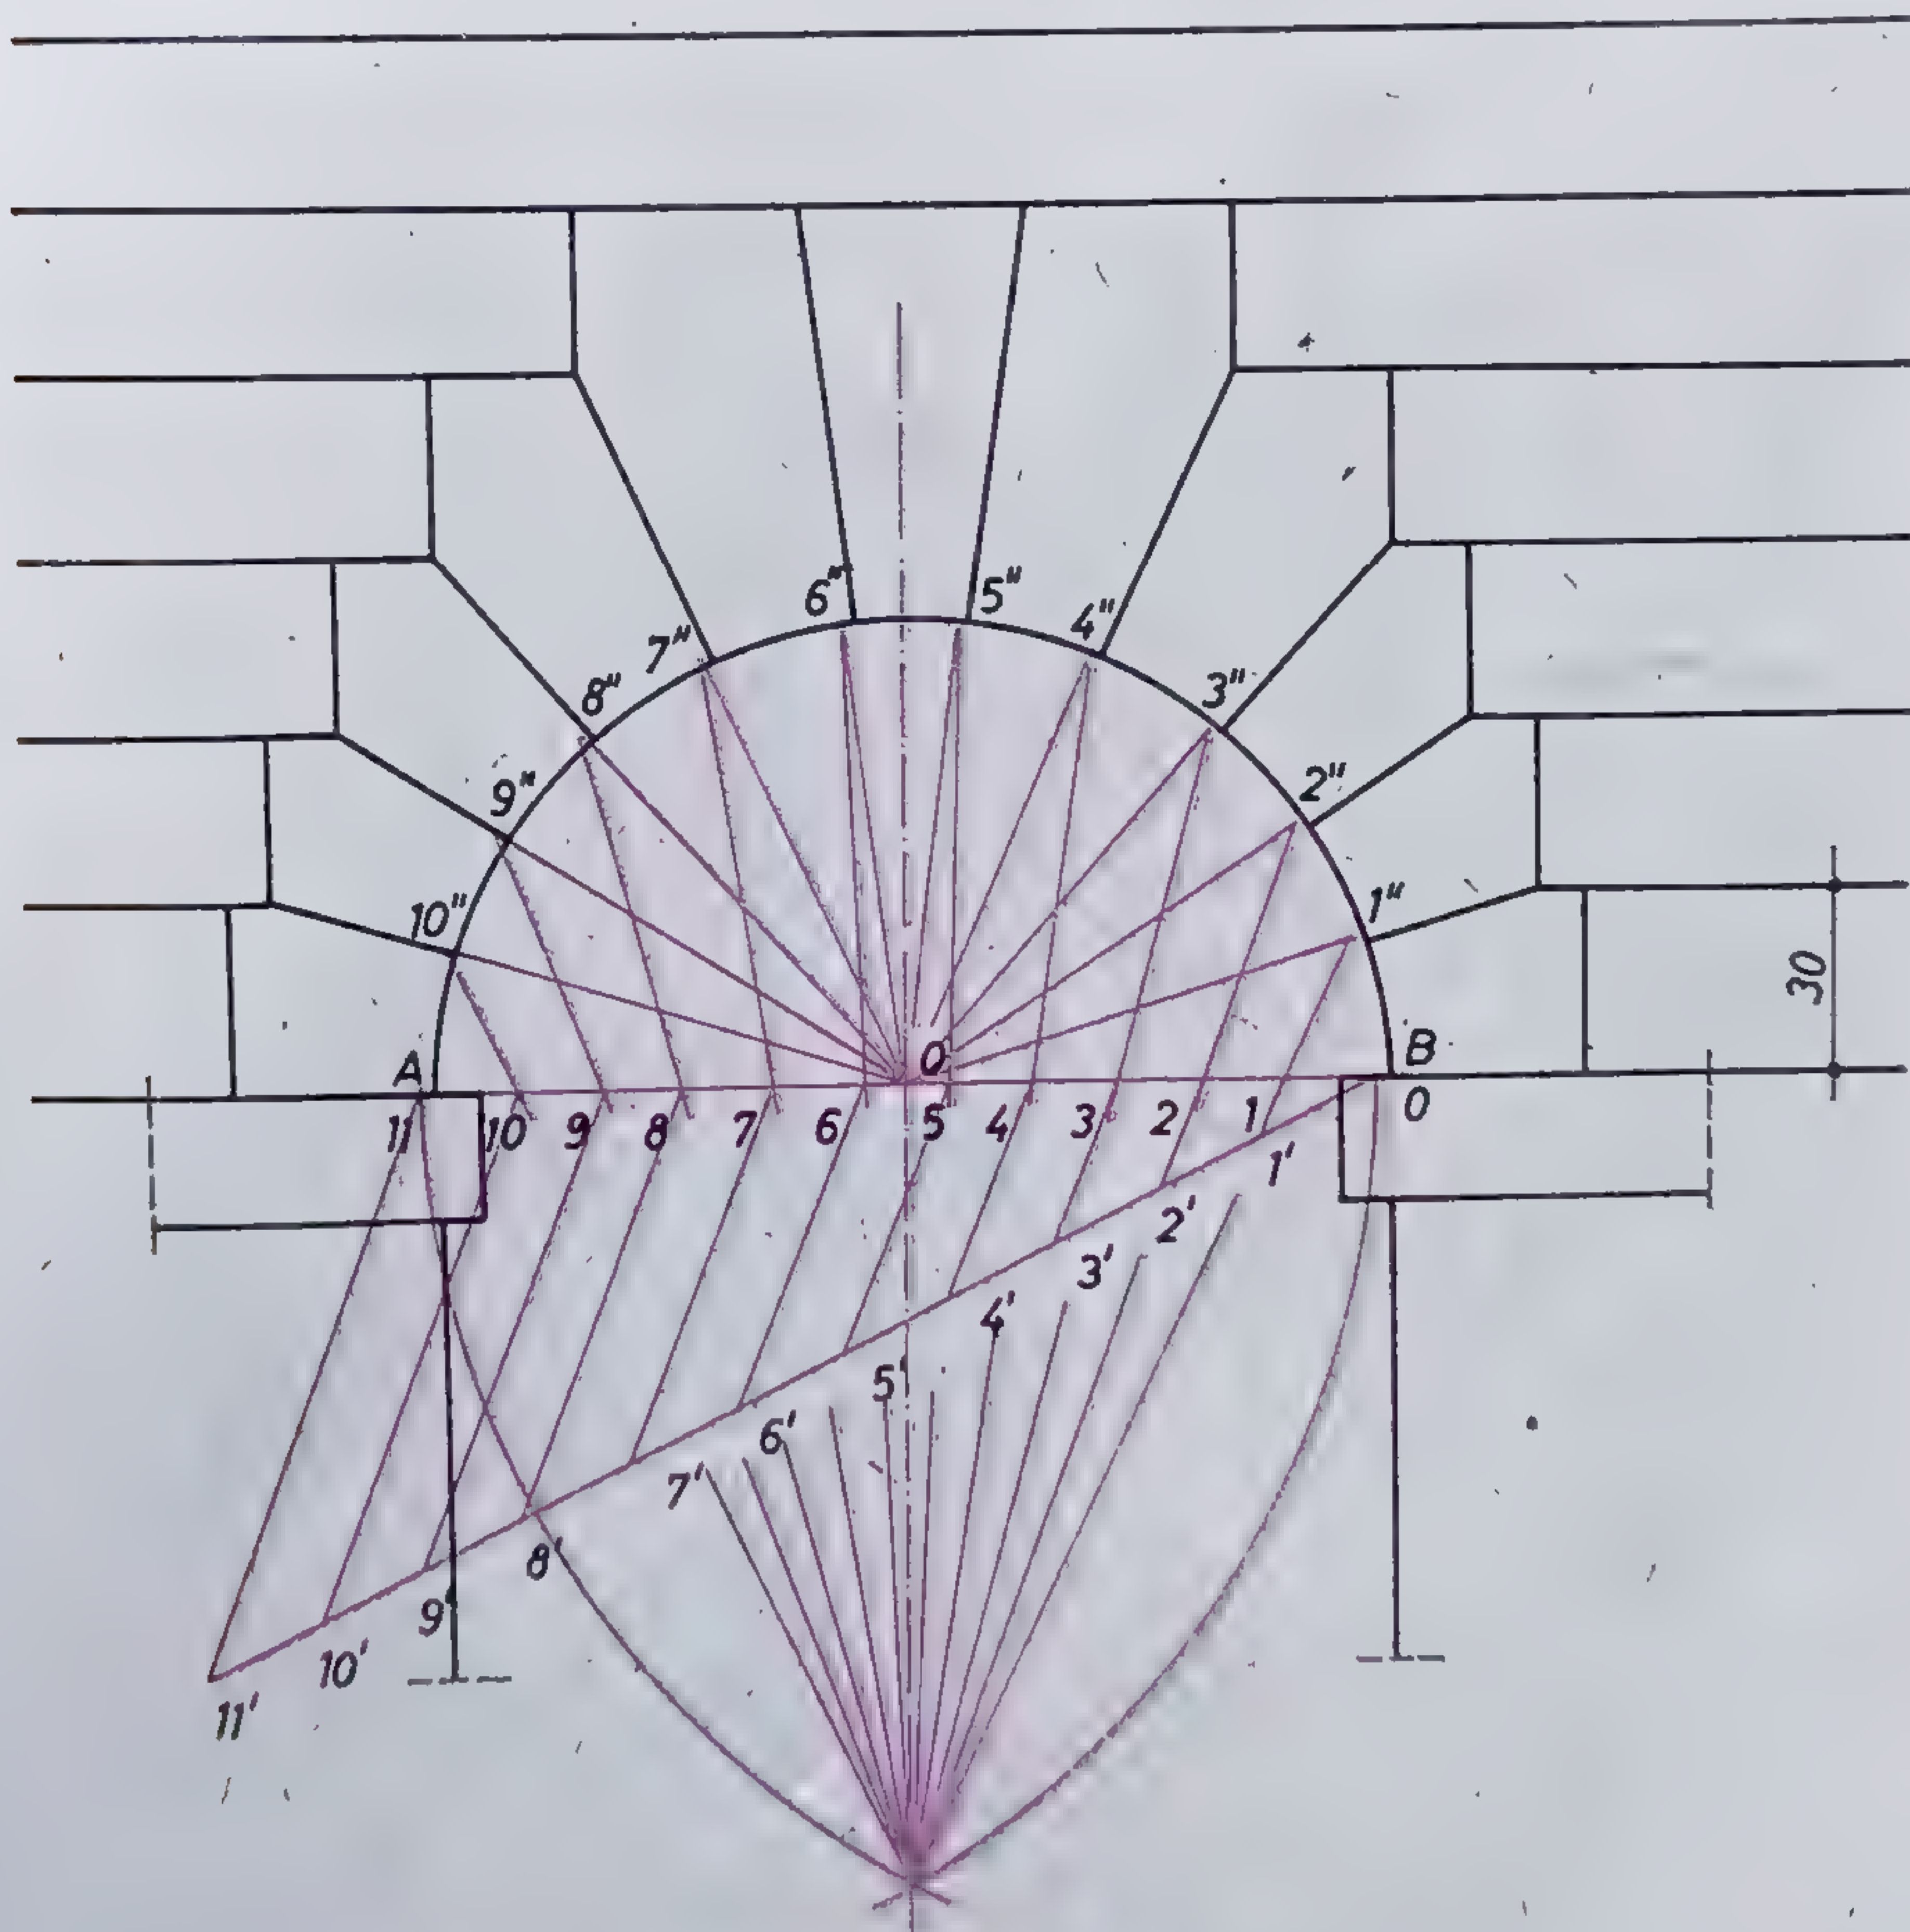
Construcția apareiajului unui arc în plin centru.
